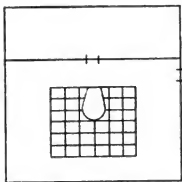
Malzdarre auf dem Grundrisse von St. Gallen.
